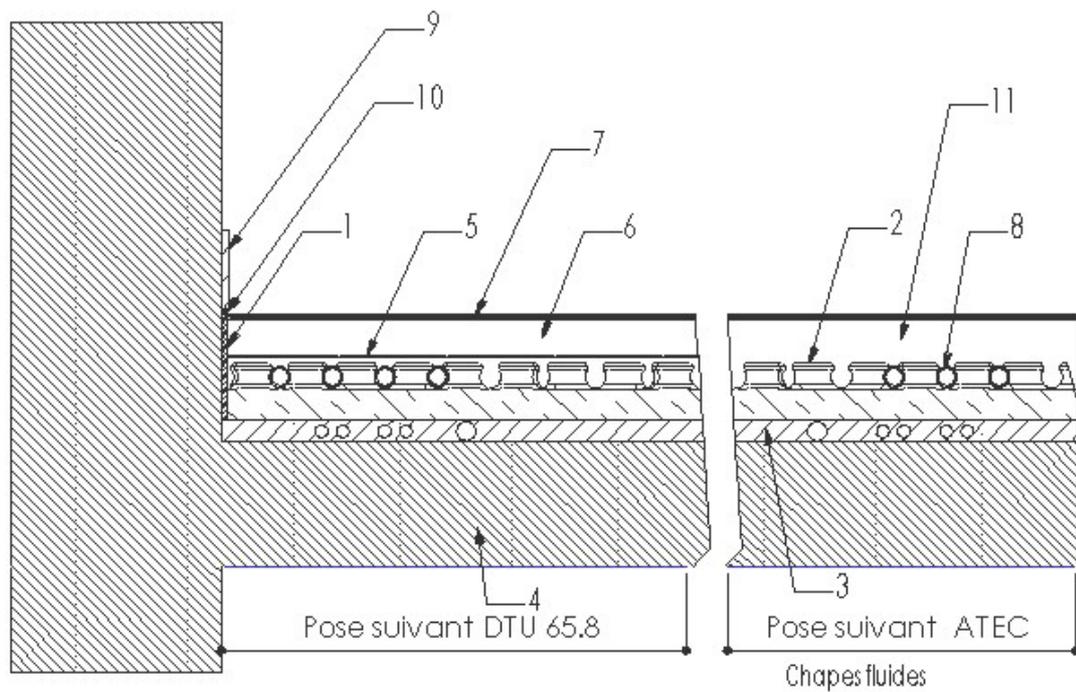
Dalles à plots isolantes sur ravoirage éventuel
